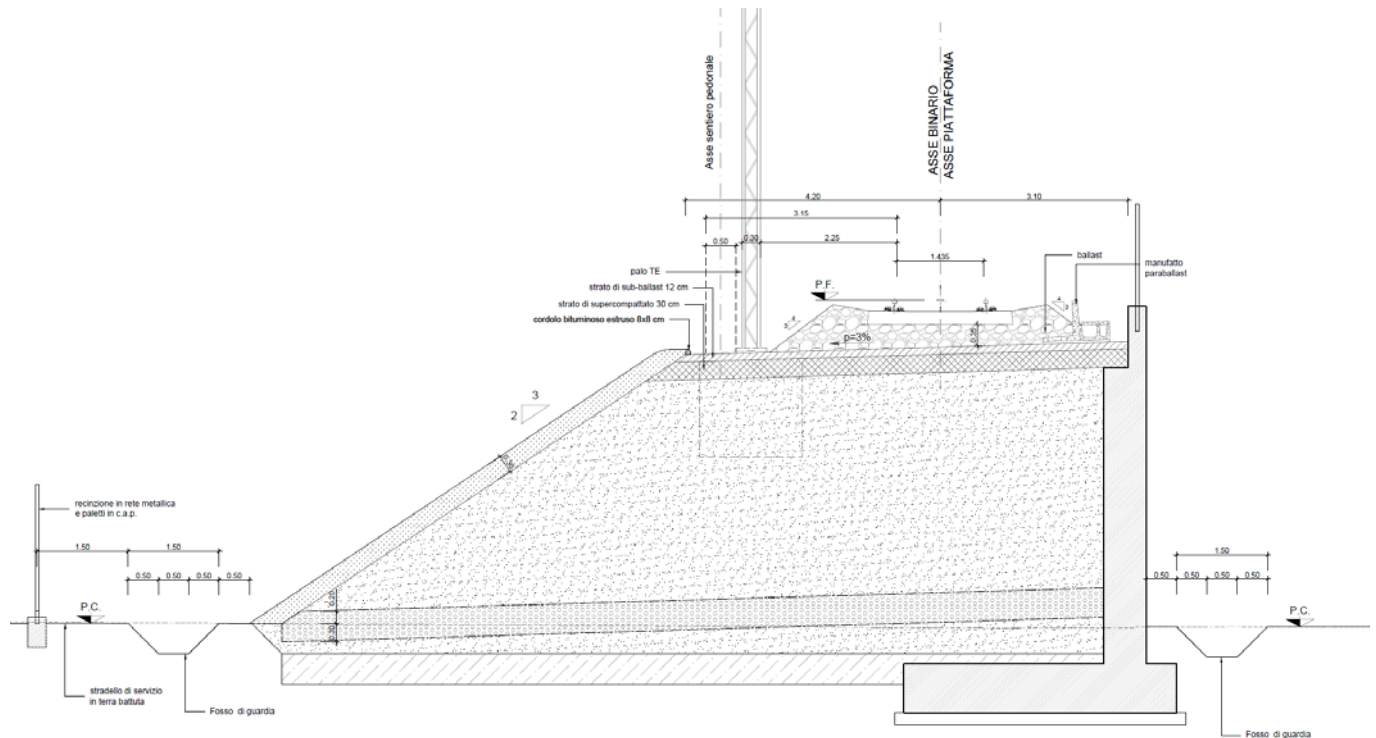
Sezione tipo a singolo binario in rilevato con muro in sezione ridotta
